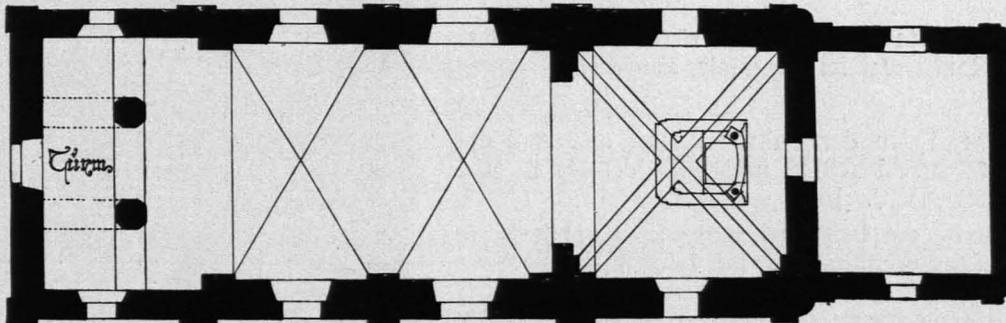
Jagenbach, Pfarrkirche, Grundriß 1:200 (S. 339)
